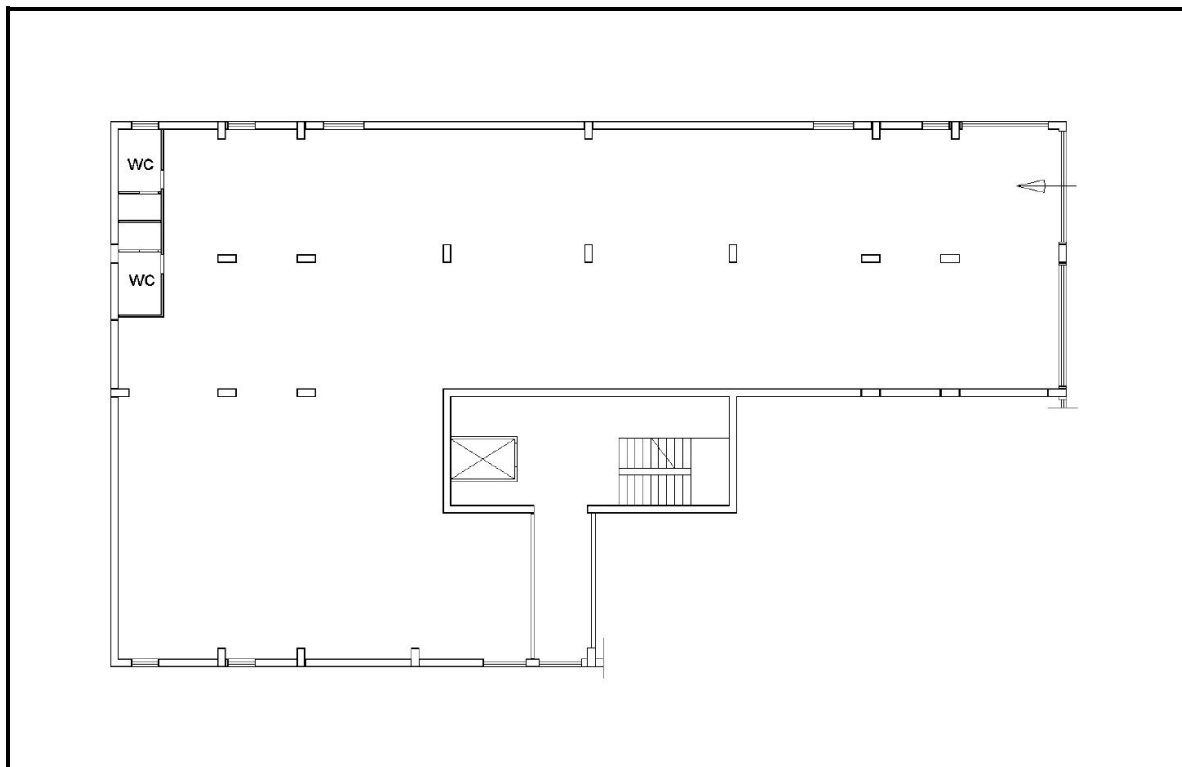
Planimetria catastale del negozio sub 41 sito al piano terra dell’edificio polifunzionale interno alla particella 1205.
